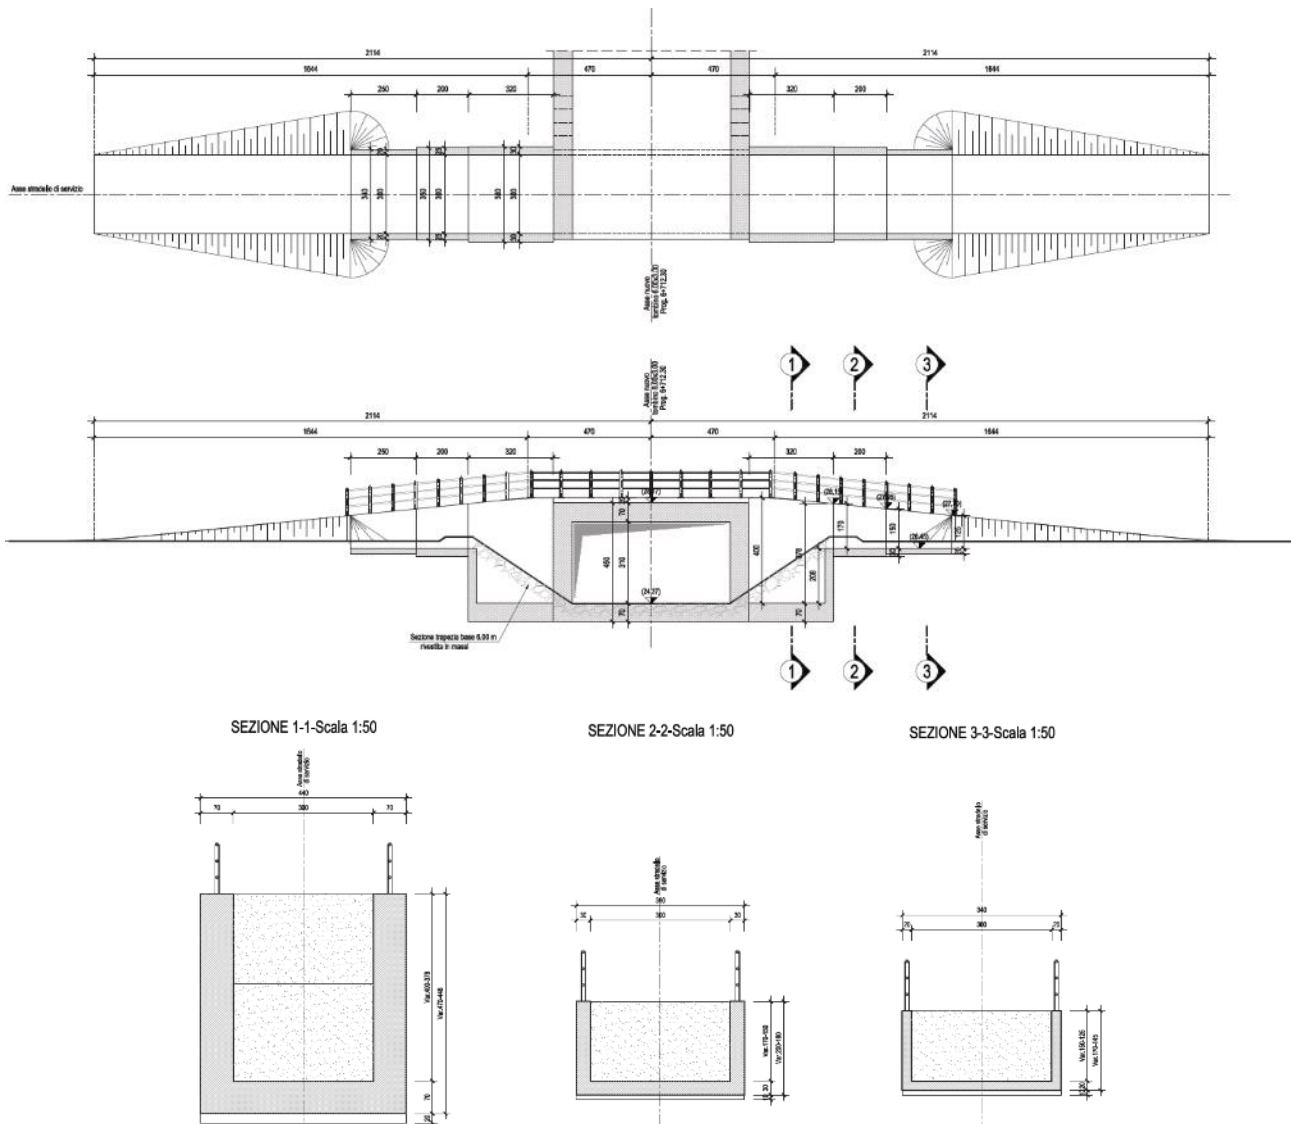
Ripristino stradello di servizio al Fosso Pontonicchio – Vista in pianta, Sezione longitudinale e Sezioni muro andatore ad “U”
